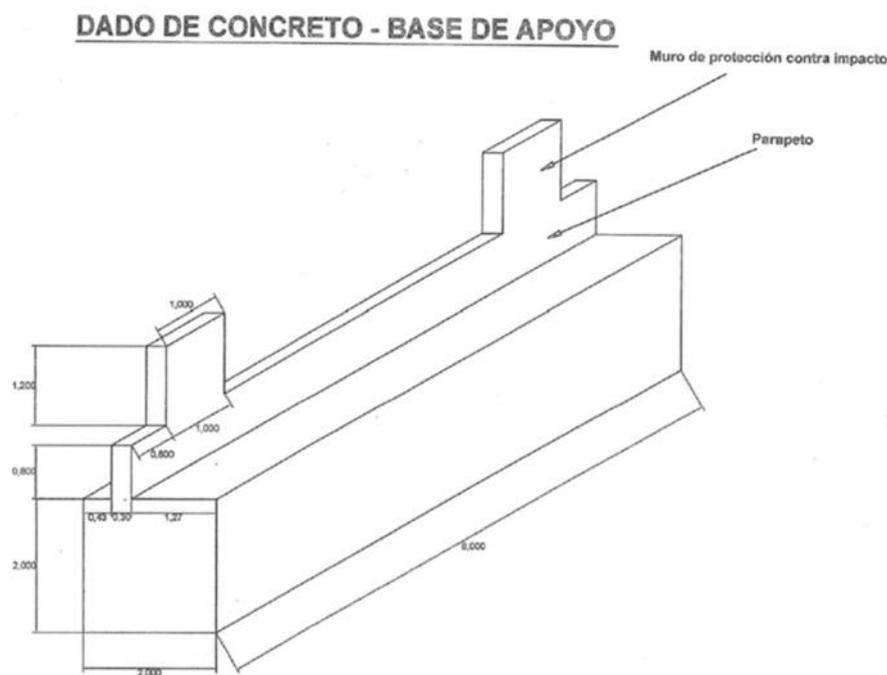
Dados e concreto para apoyo de la estructura metálica modular
